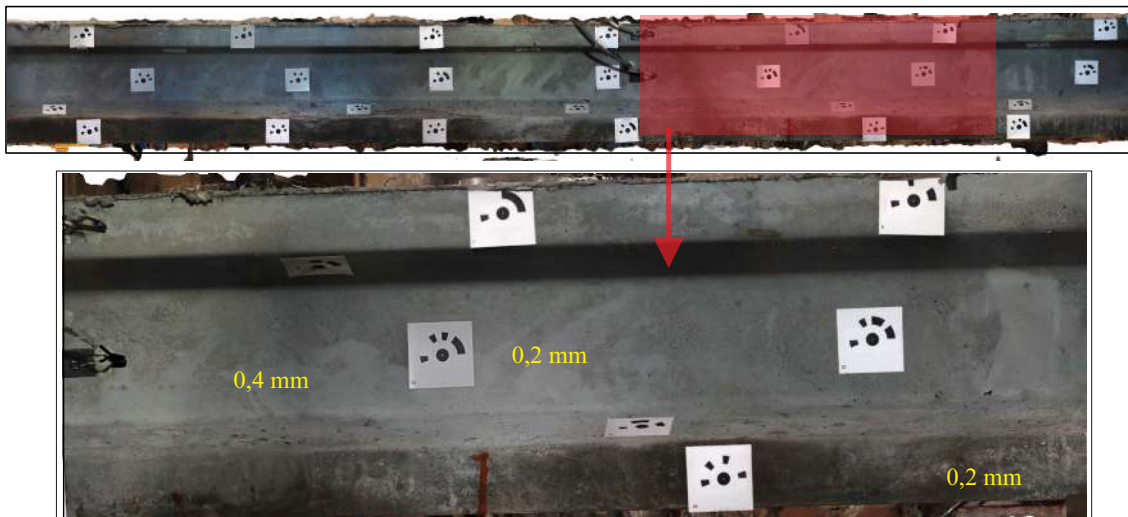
Fissuras no 3º ciclo da viga UHPFRC-P-Flex-Cis
